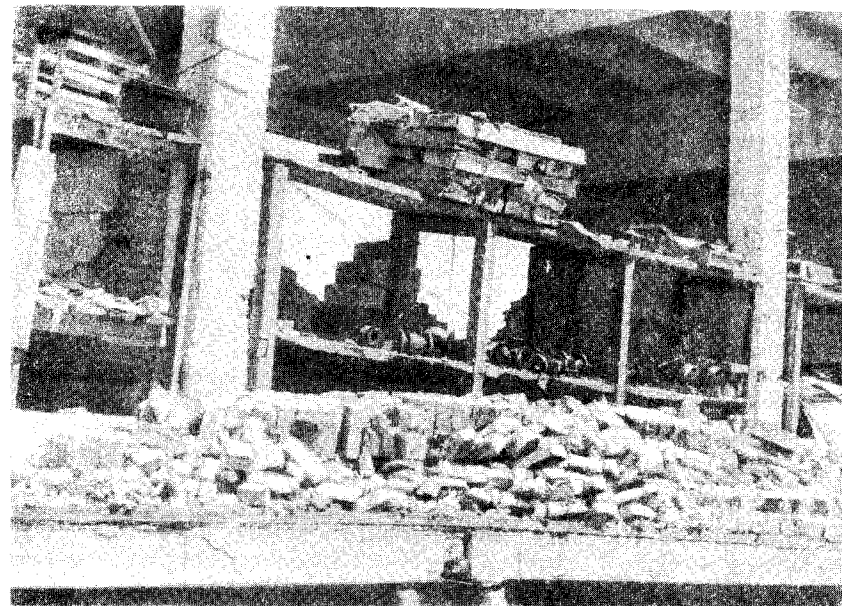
30. Обрушение стен, сквозные трещины и выколы бетона в колоннах склада №2 ГНПУ
